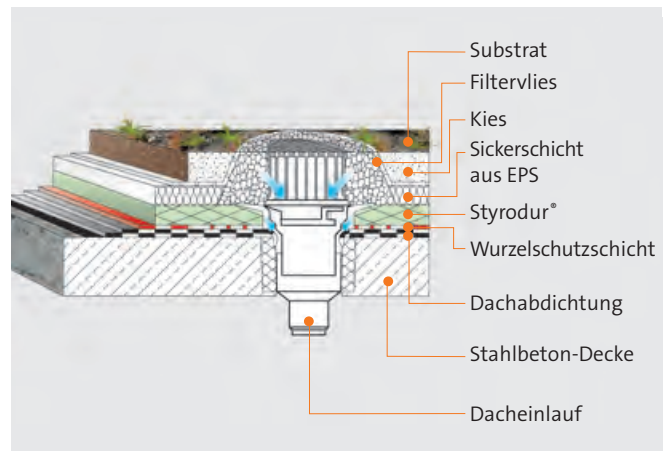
Dacheinlauf bei einem UK-Gründach mit einer Dränschicht aus EPS-Dränplatten.
